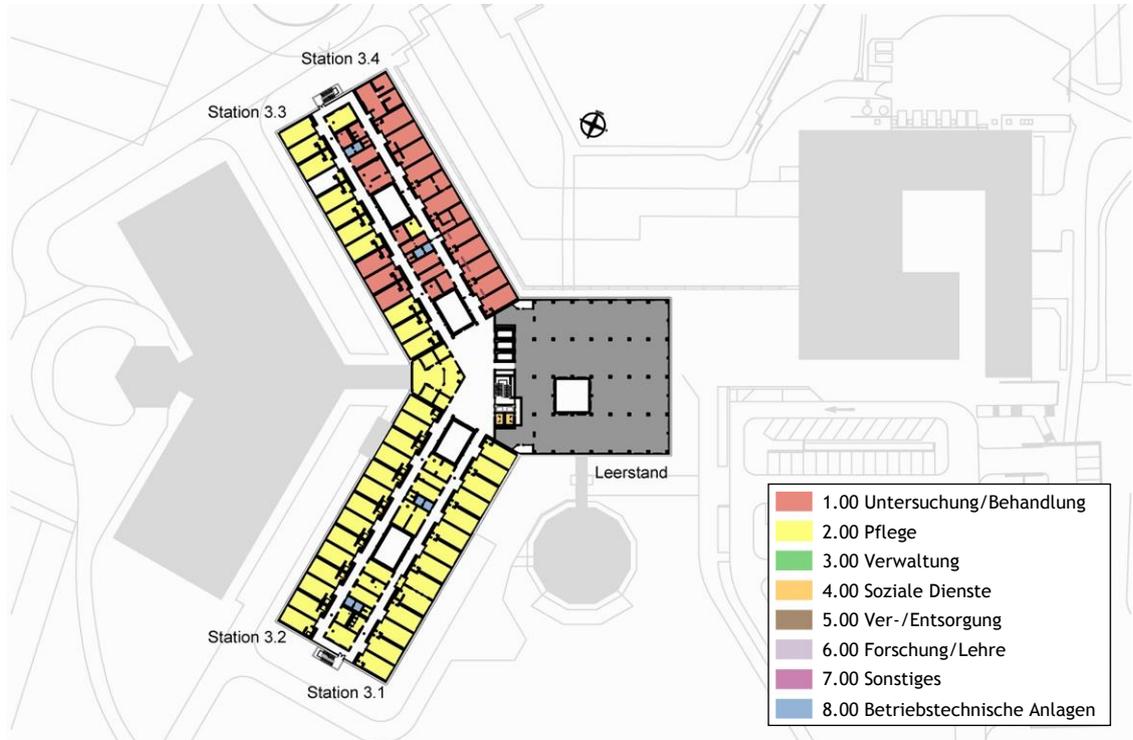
Bestandsflächen nach DIN 13080 - 3.Obergeschoss
